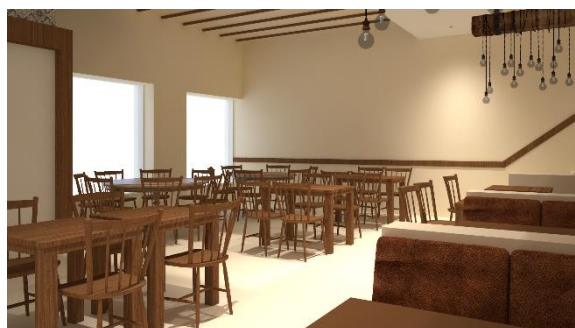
Renderização 3D, vista sala 1 e entrada.
